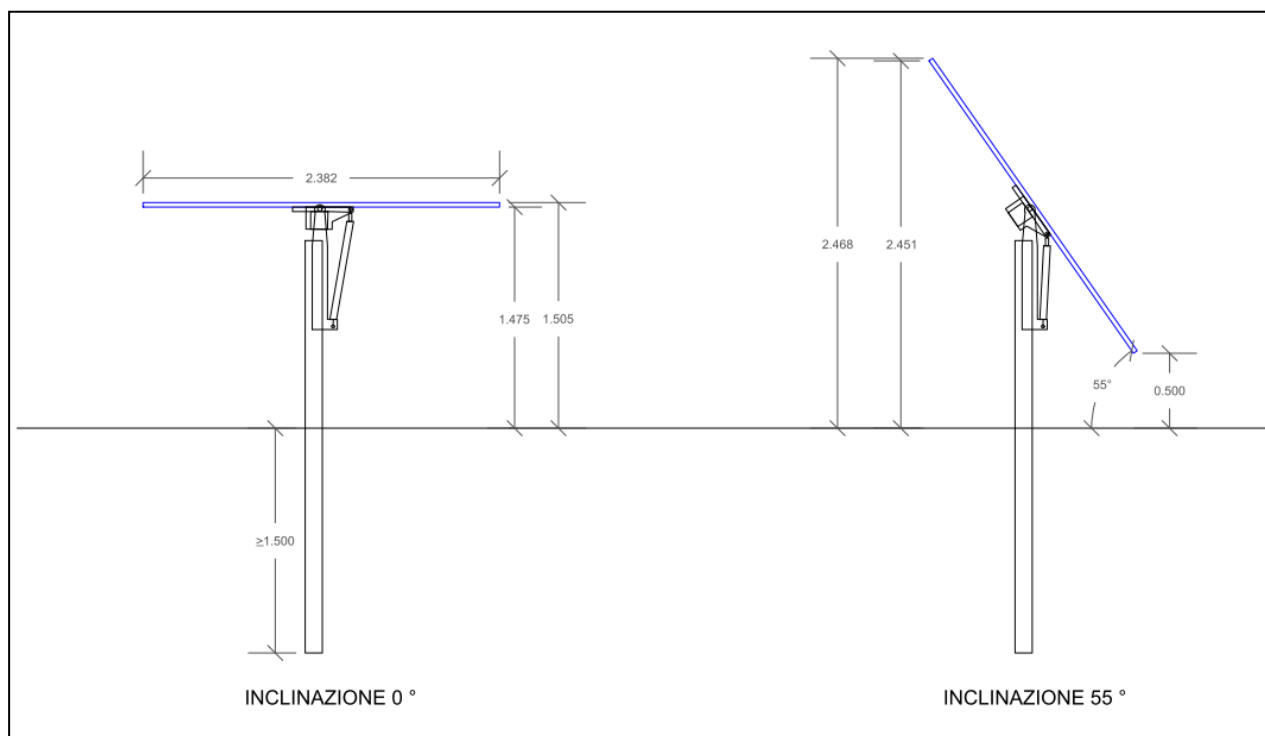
Struttura di sostegno metallica dei moduli fotovoltaici (prospetto).
